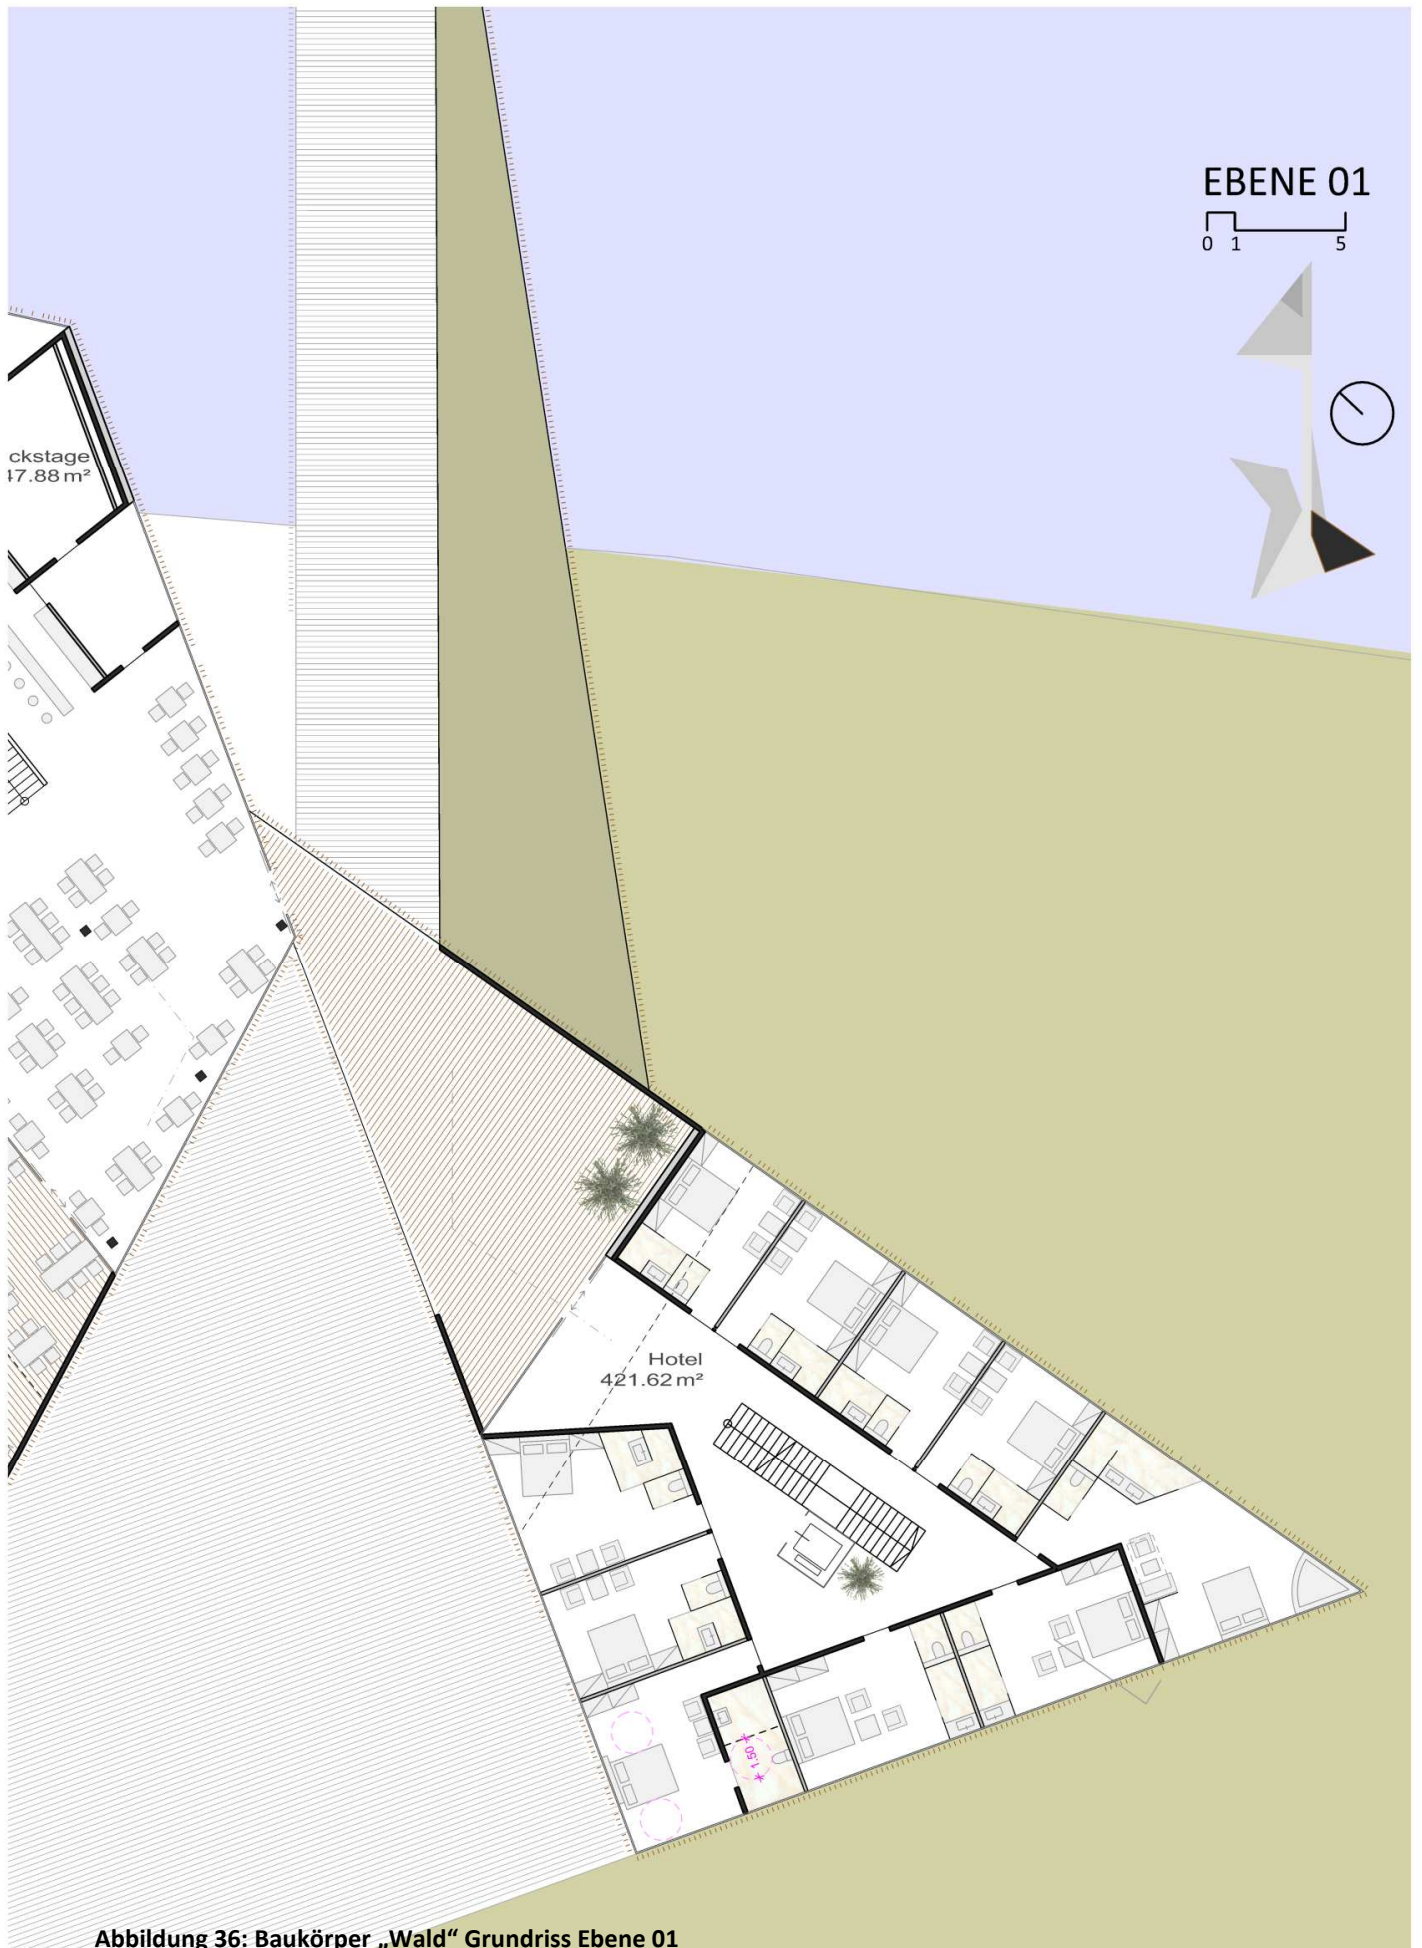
Baukörper „Wald“ Grundriss Ebene 01
